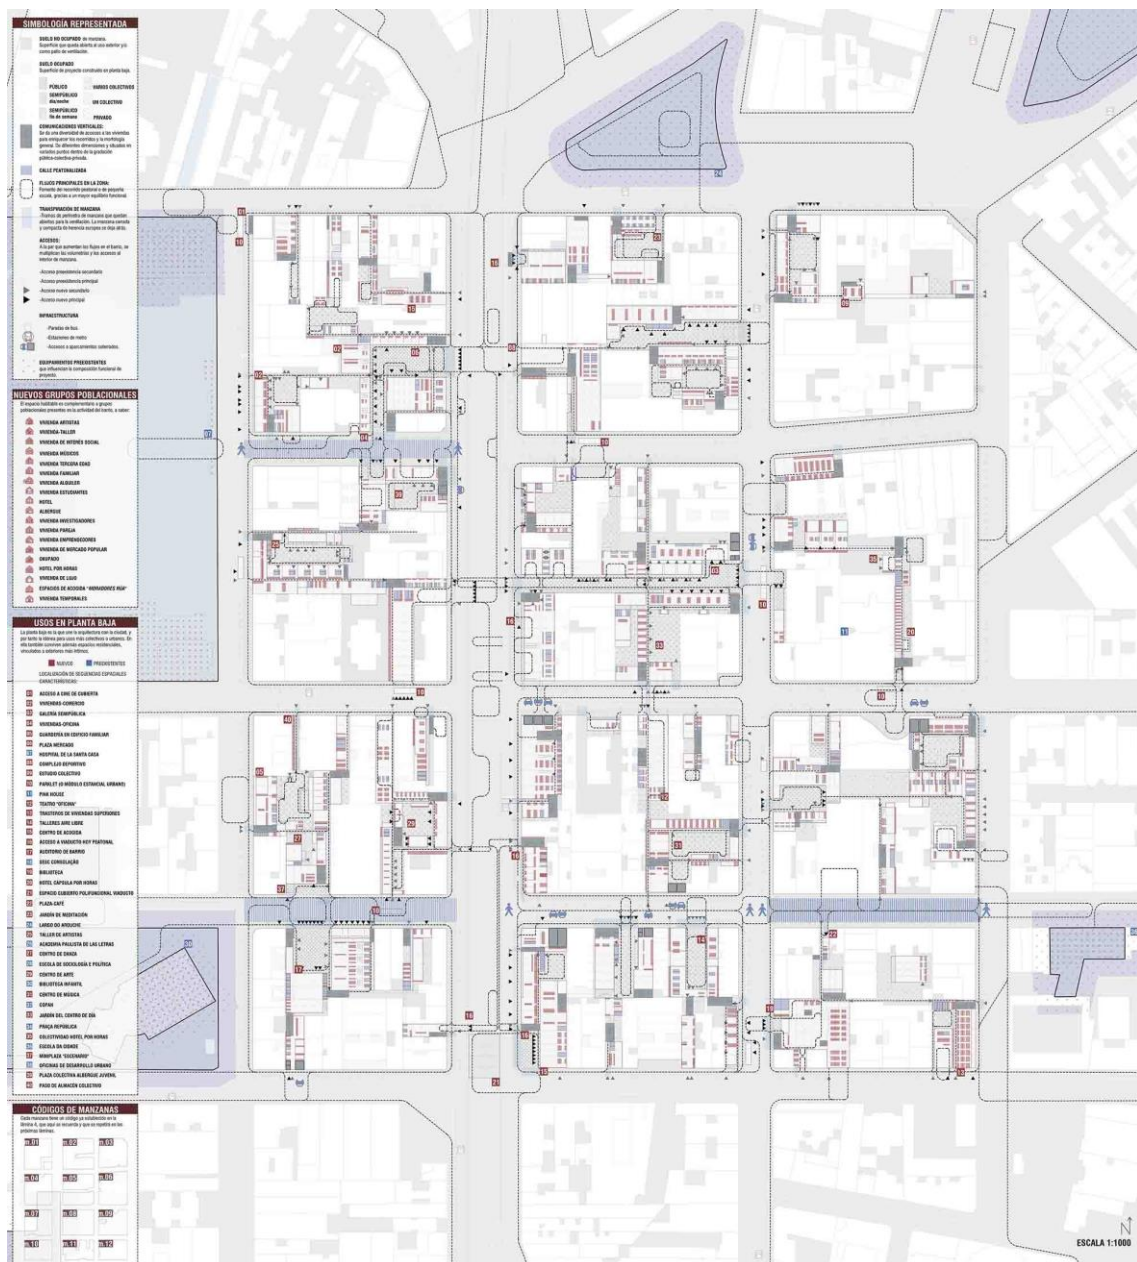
Desarrollo del sistema en el caso específico de la ZEIS CO.02+RE.13. Planta baja (Imagen propia, 2018)
